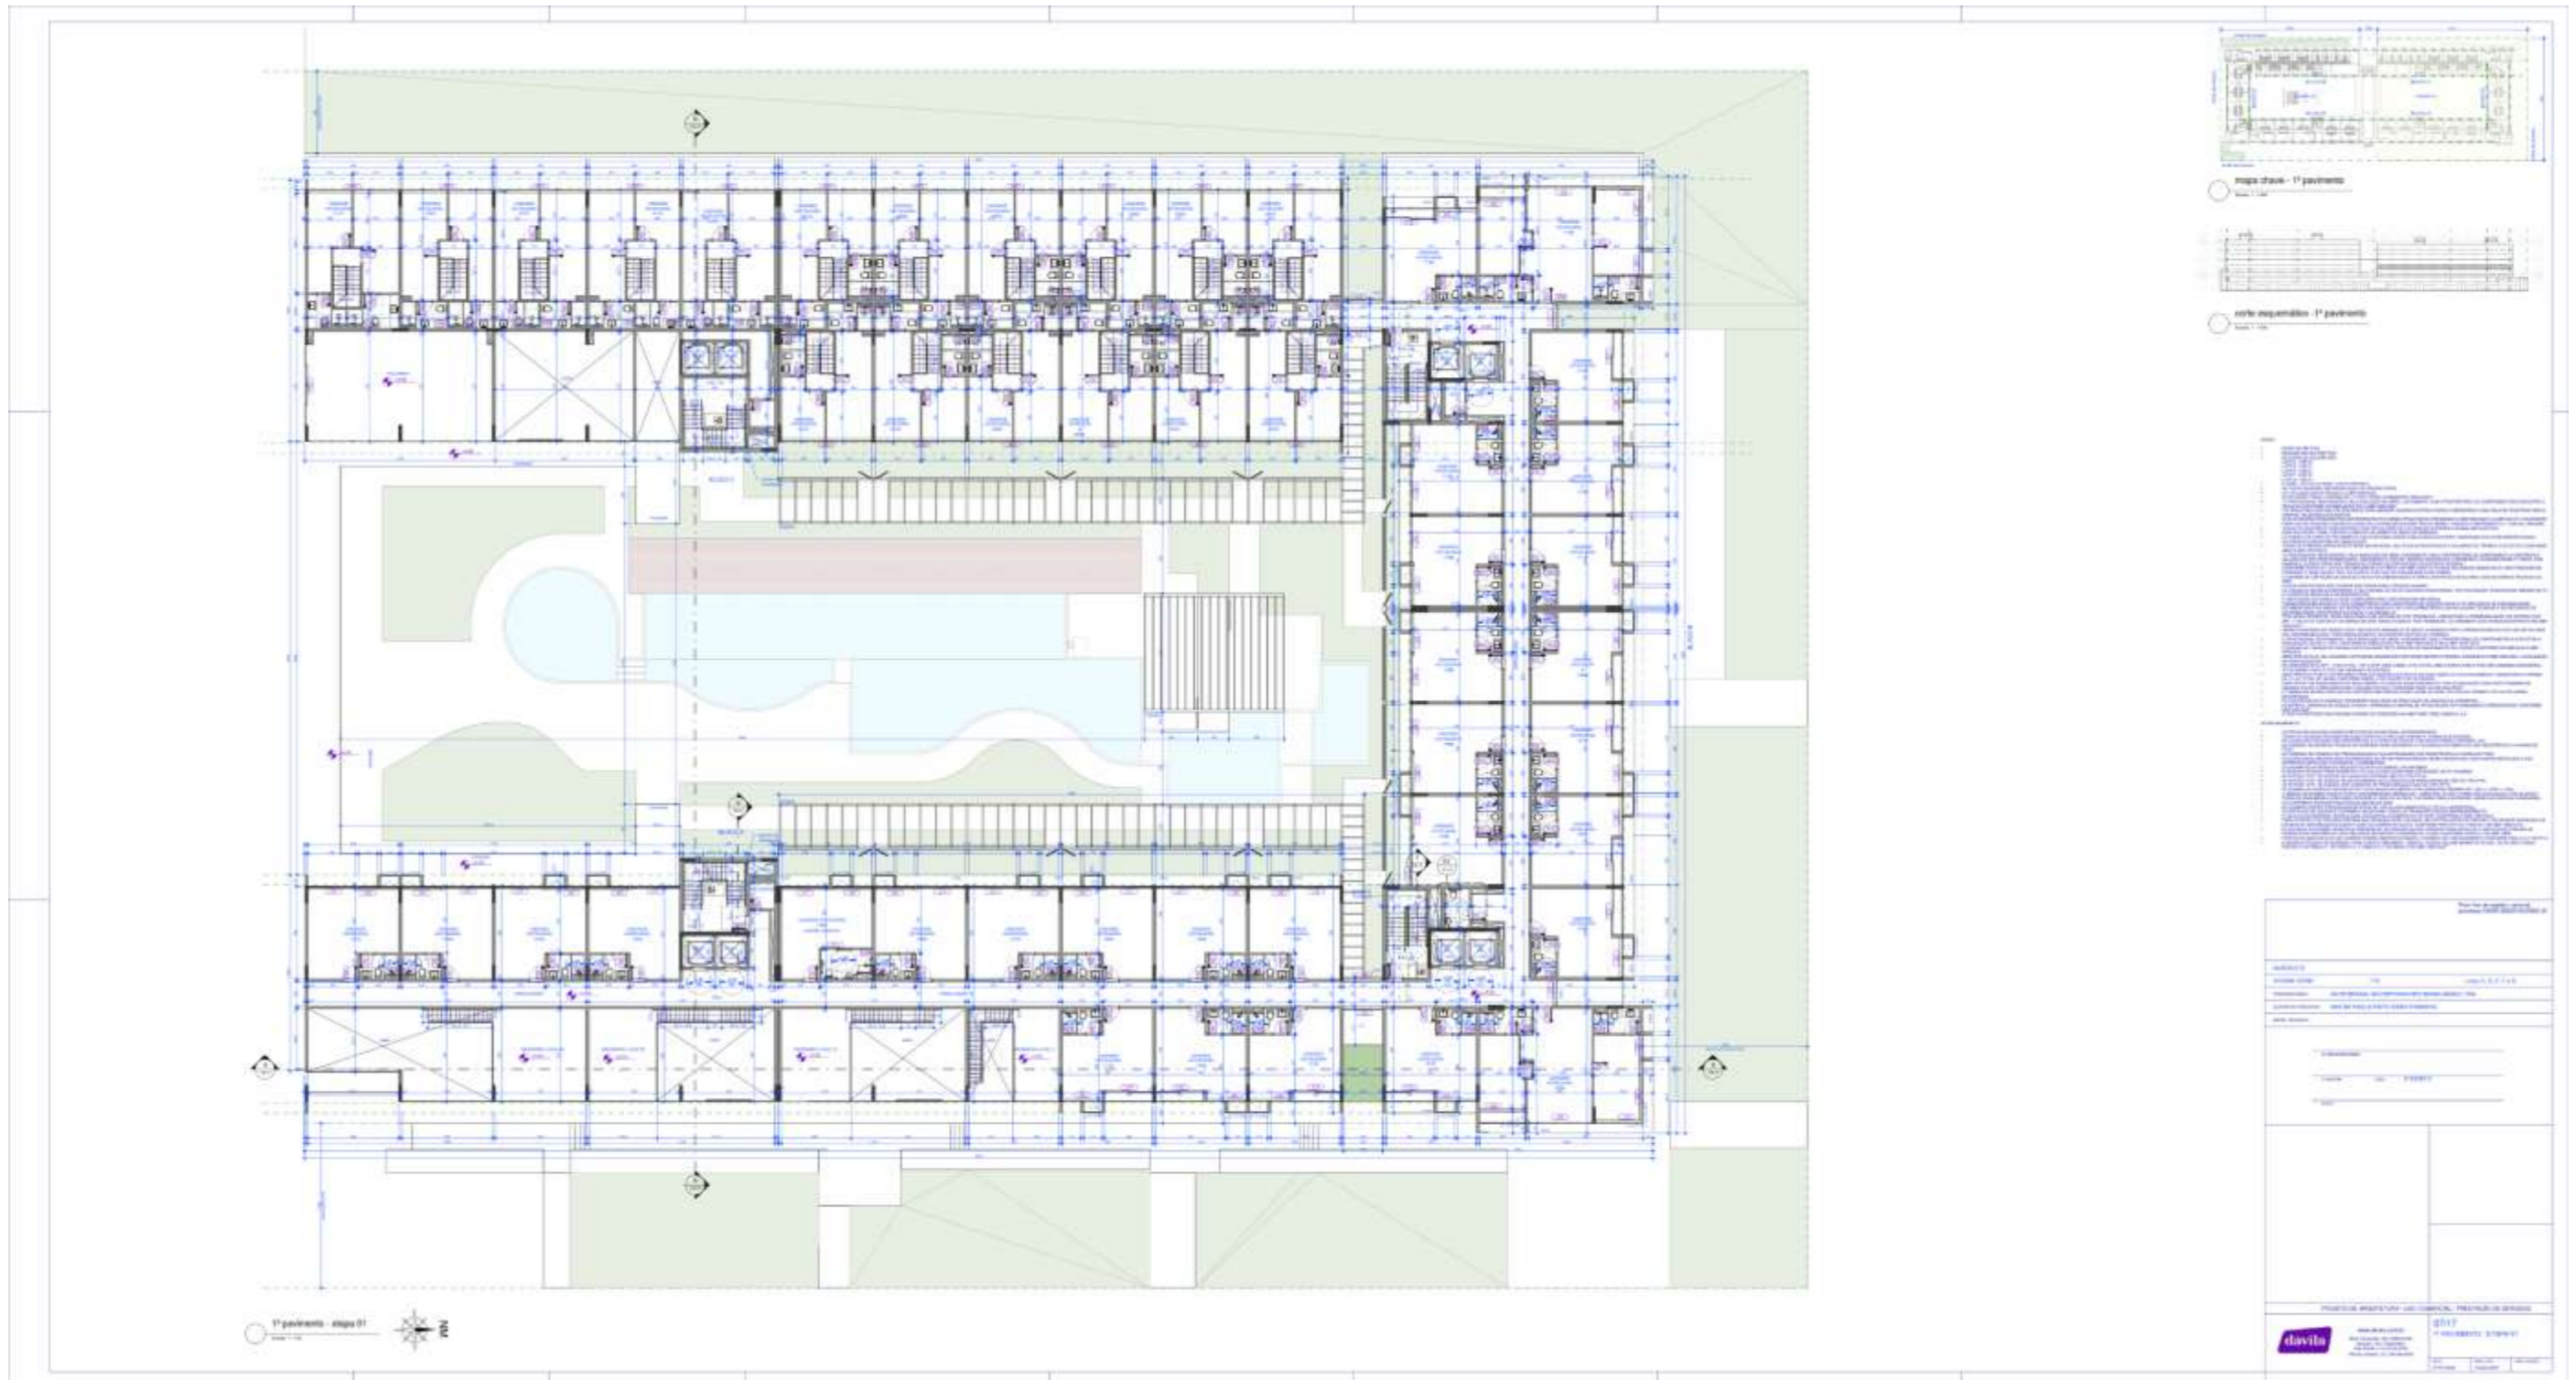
Planta do 1º Pavimento – Etapa 01. Fonte: Estudo Preliminar, em anexo.
